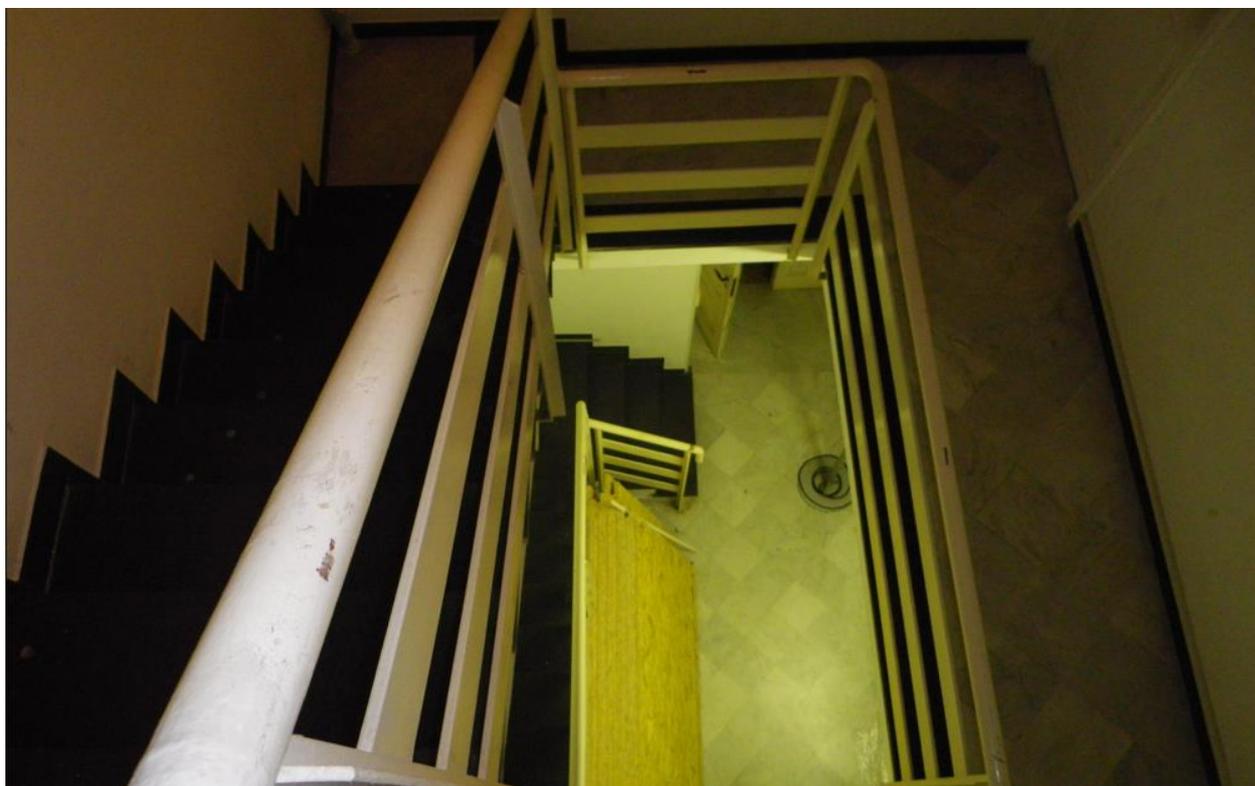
Interni dettaglio sviluppo scala di servizio vista da quota piano primo verso piano terra
